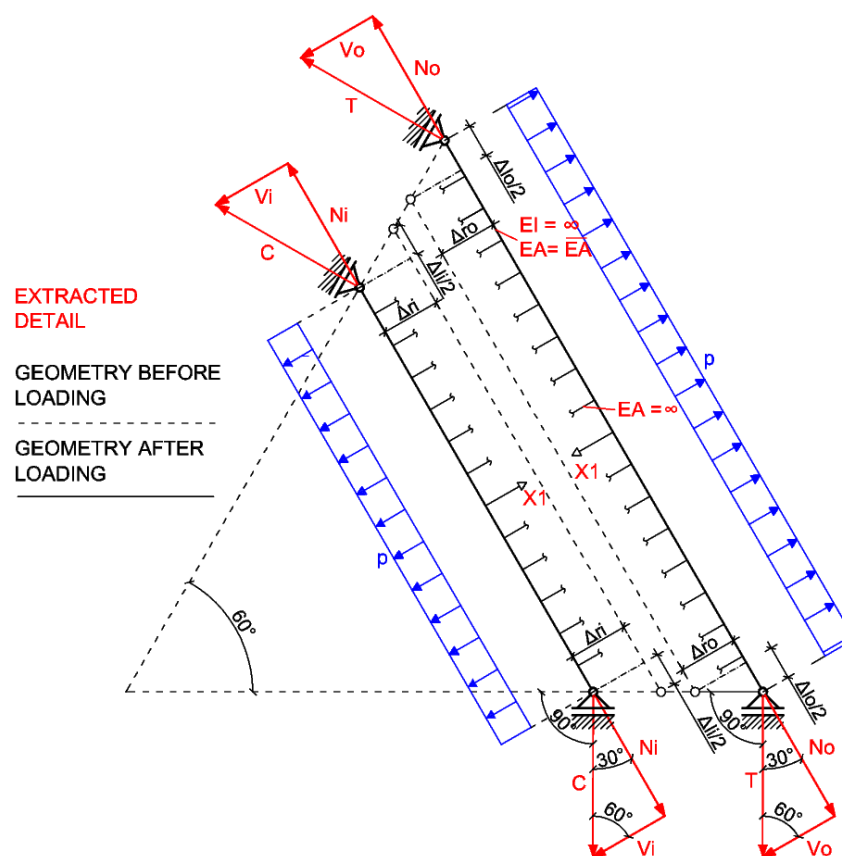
Statisches System eines Doppelwandelements im Grundriss unter Frischbetondruck bei einem sechseckigen Segmentring und Kopplung beider Doppelwandplatten [38]
